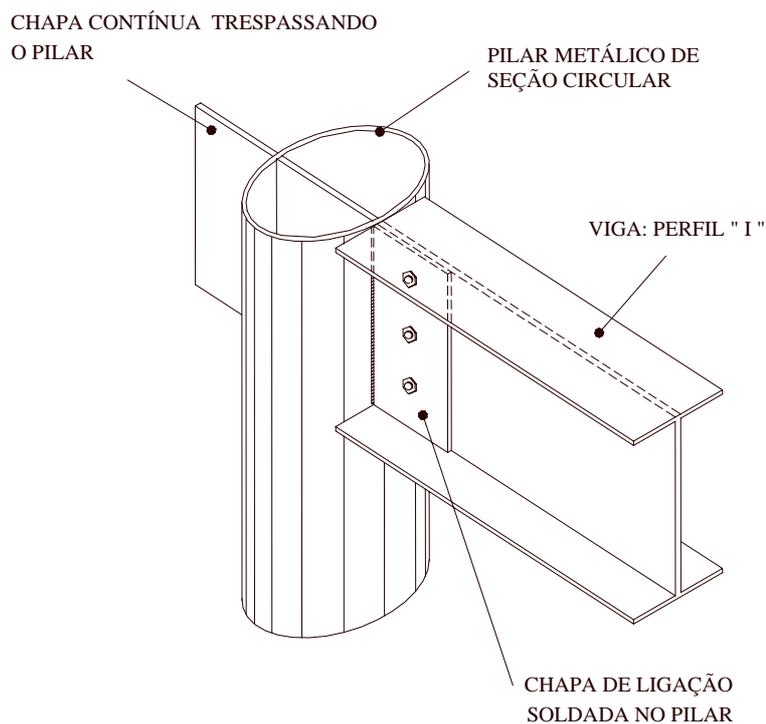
Detalhe da ligação entre a viga “I” e o pilar através de chapa contínua.
